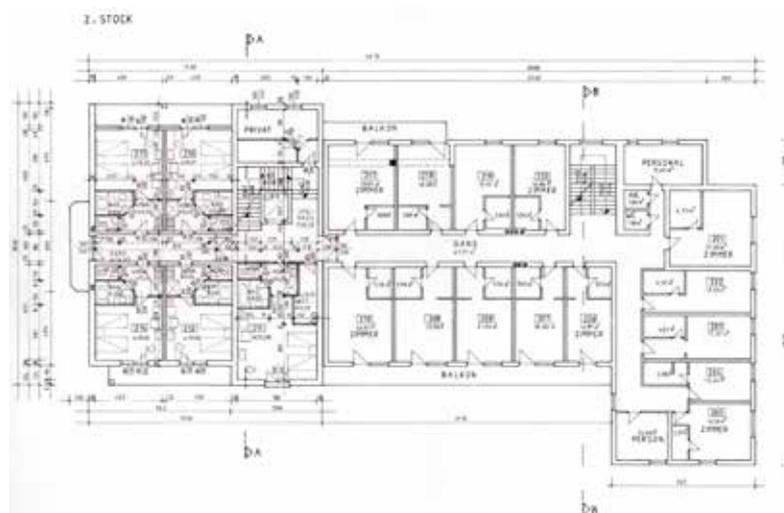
Waldhofhotel: Grundriss 2.OG
